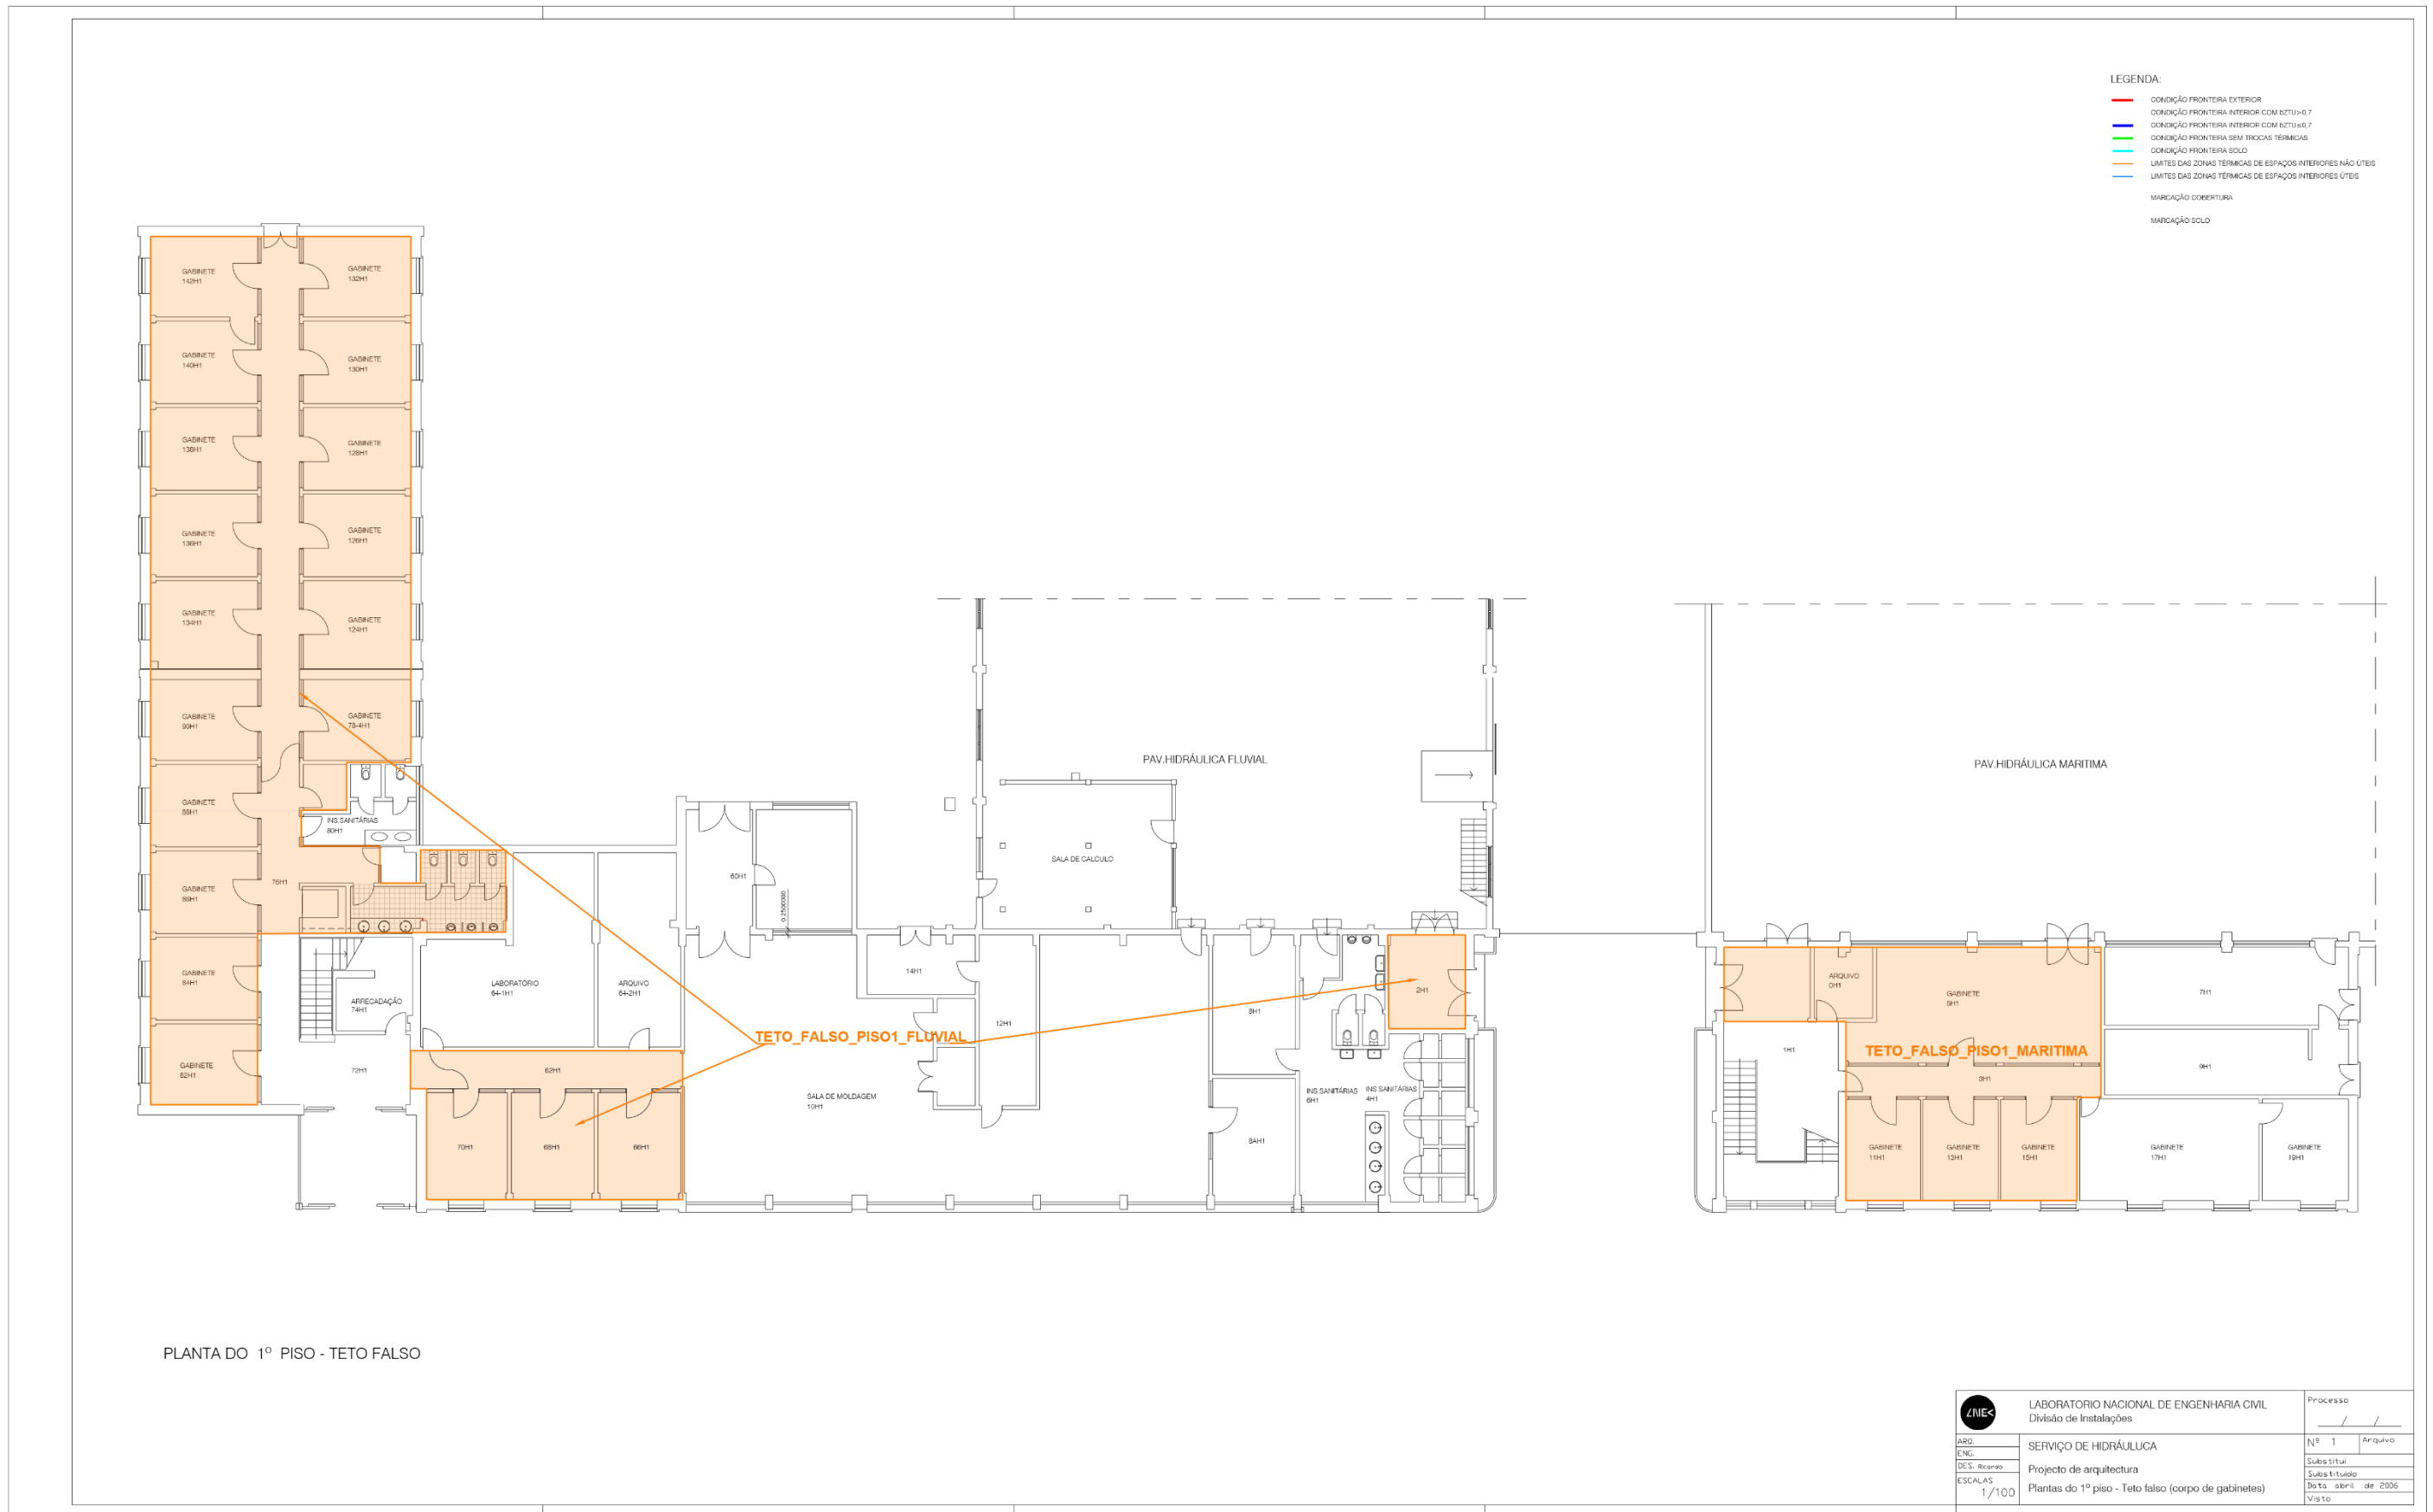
Figura – Planta do 1º Piso - Teto Falso: Identificação das zonas térmicas
